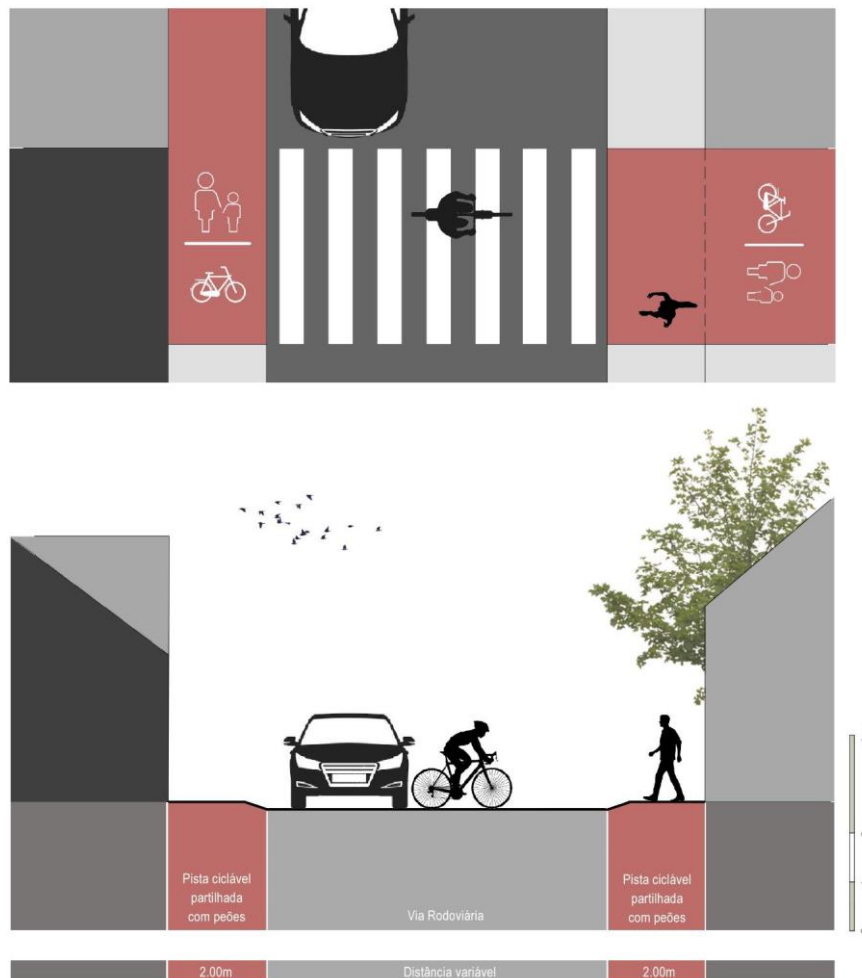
Exemplo de perfil tipo de intersecção com a via rodoviária. Planta e Corte. Fonte: Vitória Zambujo, 2018.
